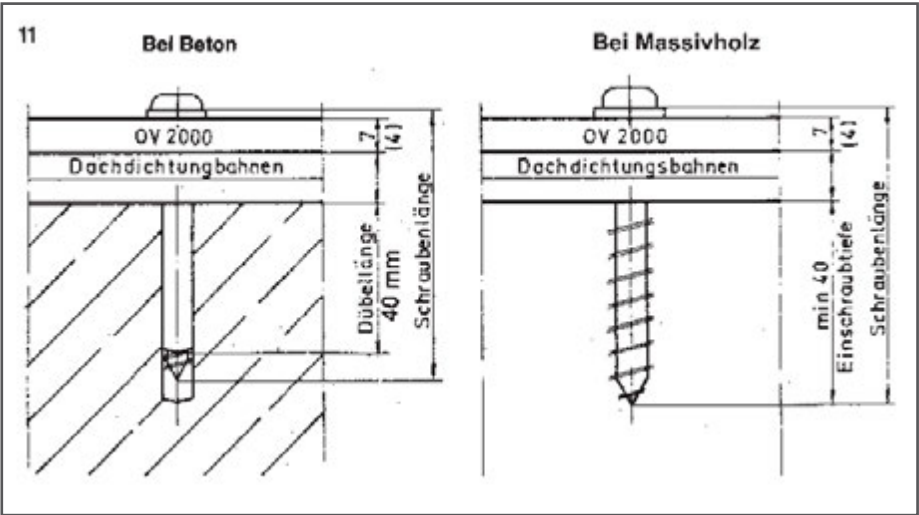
Zur Befestigung sind folgende korrosionsbeständige Schrauben zu verwenden.
